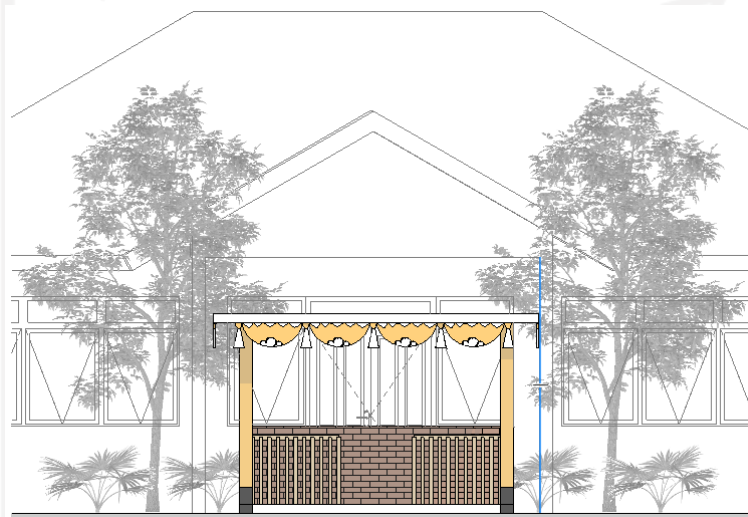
153 Gaya Perisai-Joglo, Rumah Tinggal, Café, Guest House, 1 Lantai
